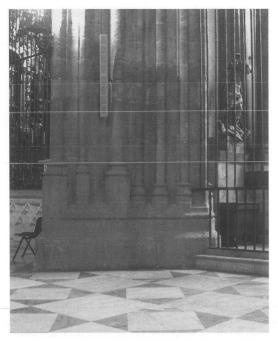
Pilar entre capillas del lado sur. (Foto del autor)
